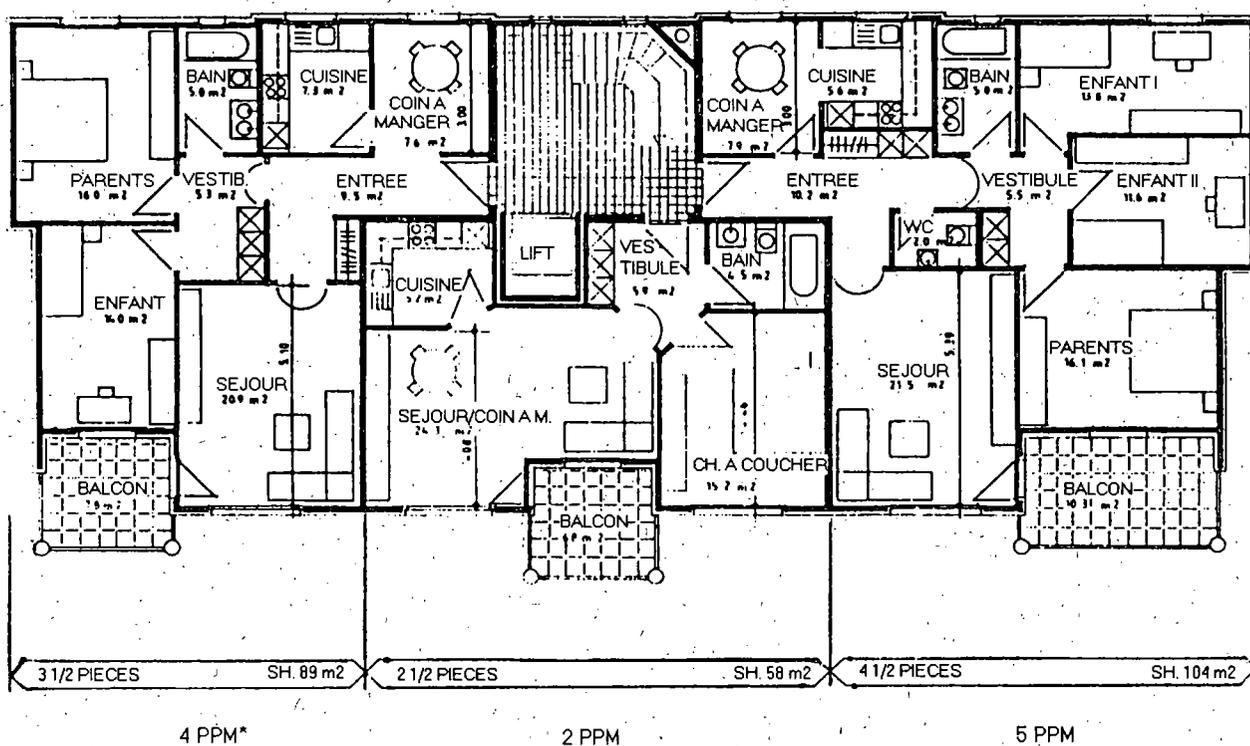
Plan du rez-de-chaussée, 1er et 2e étages
